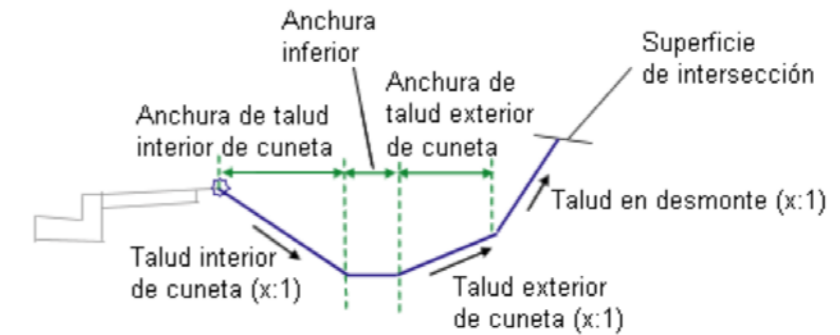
Características de las cunetas en desmorte. (Fuente: AutoCAD Civil 3D).
